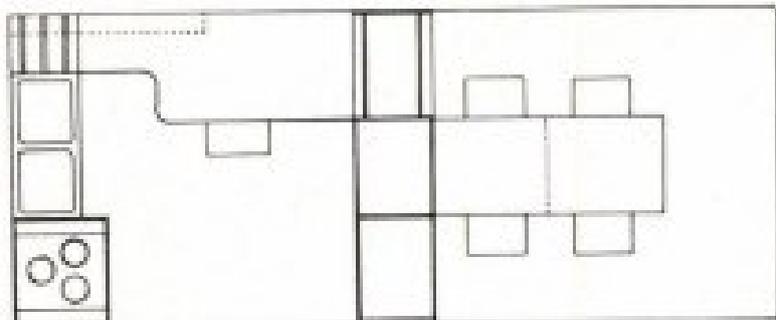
Grundriss für die kleine Küche und Esszelle
